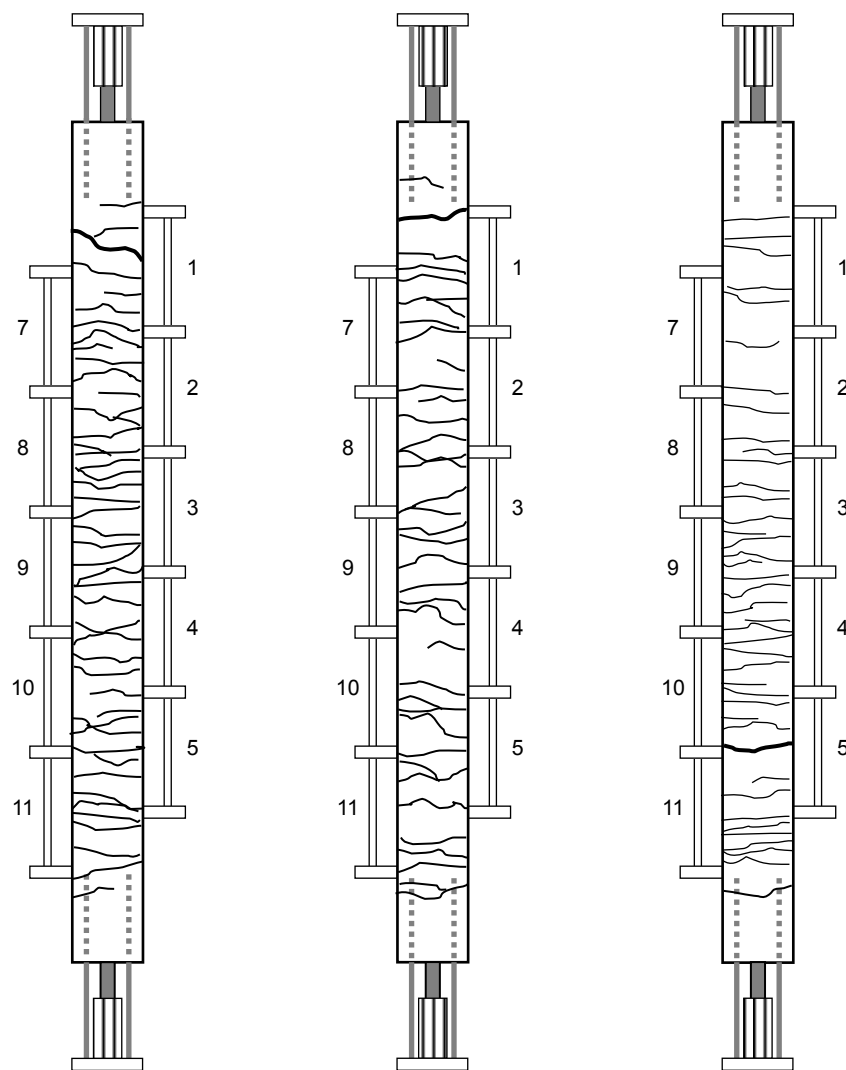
両引き試験体のひび割れ図(TS16-y)
